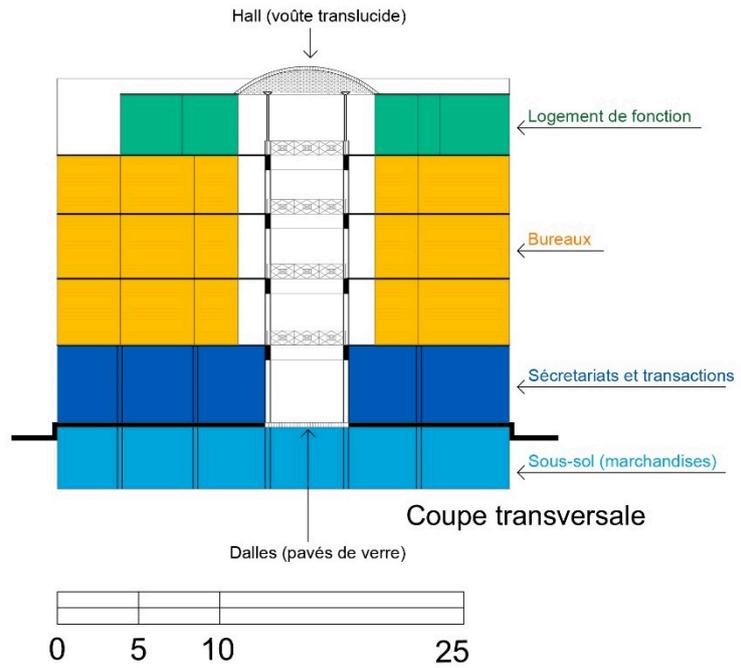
Reconstitution de la coupe transversale du bâtiment CIDOSA, AMPC.
